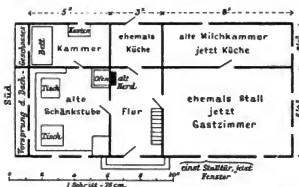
Grundriss des Lutherhauses, jetzt in Sonneberg (Thüringen).
